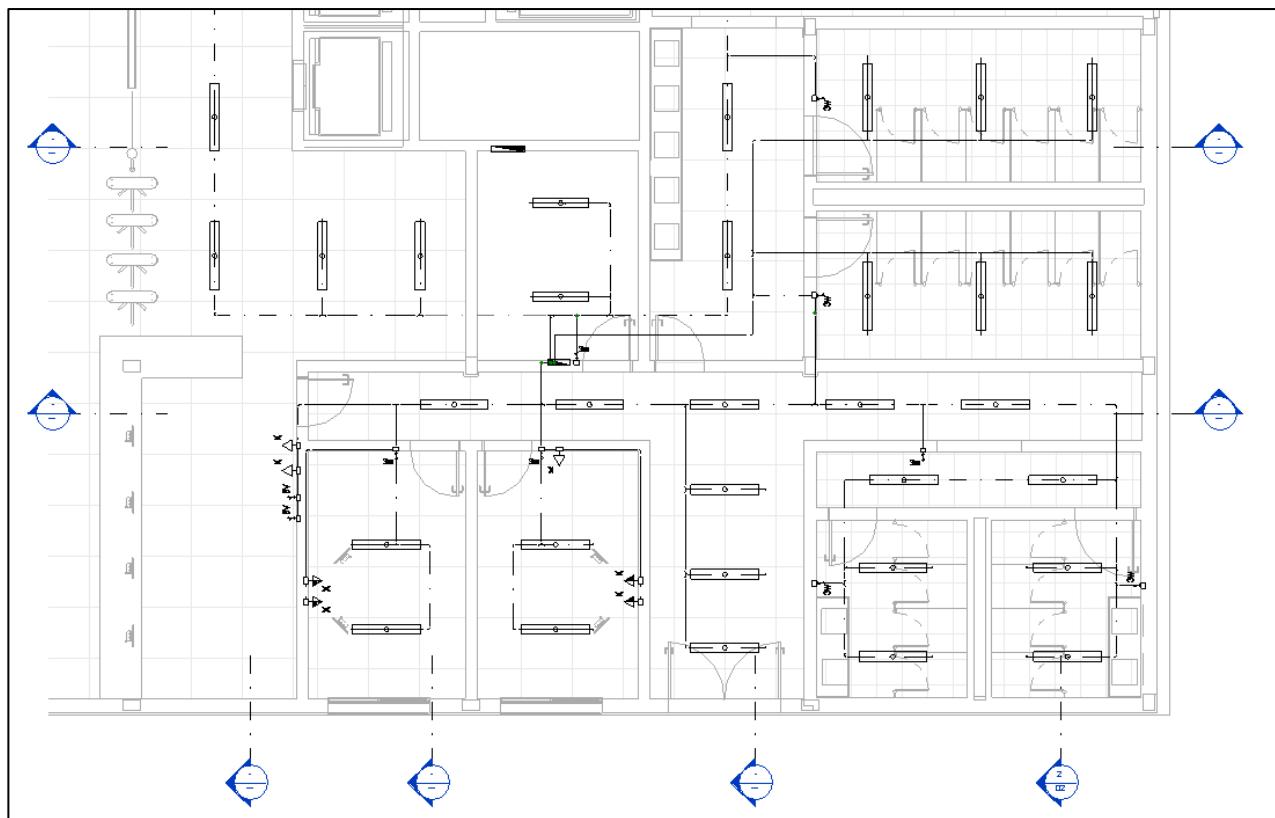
PLANTA COM VIEW TEMPLATE APLICADO.
